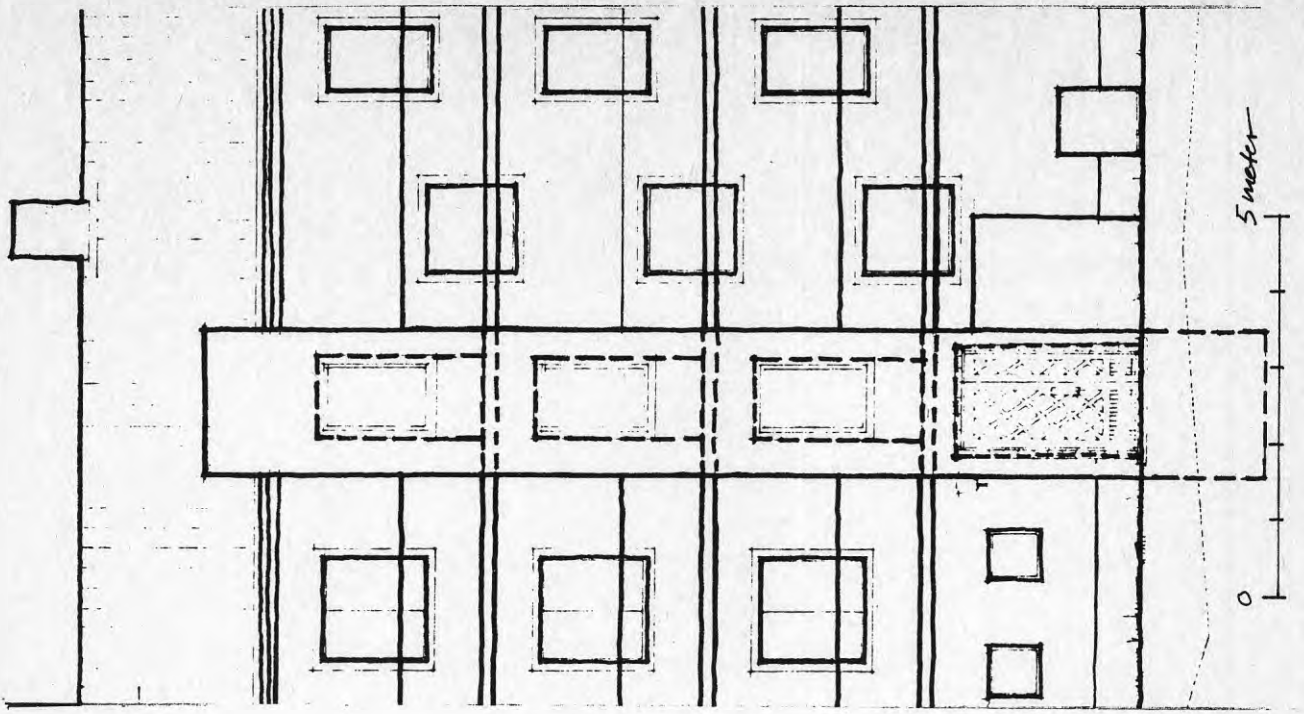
Kv. Skyfalllet 1 (Entréfasad
